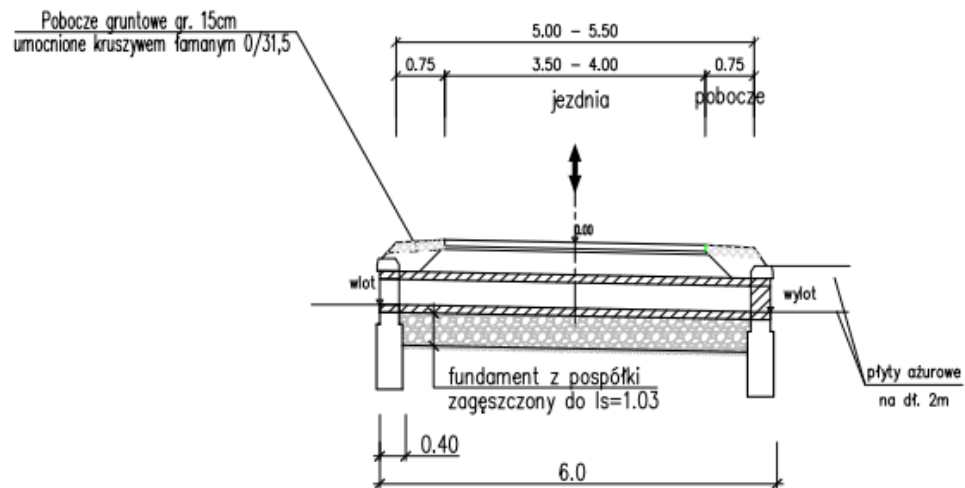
widok konstrukcji przepustu średnicy 600 mm
